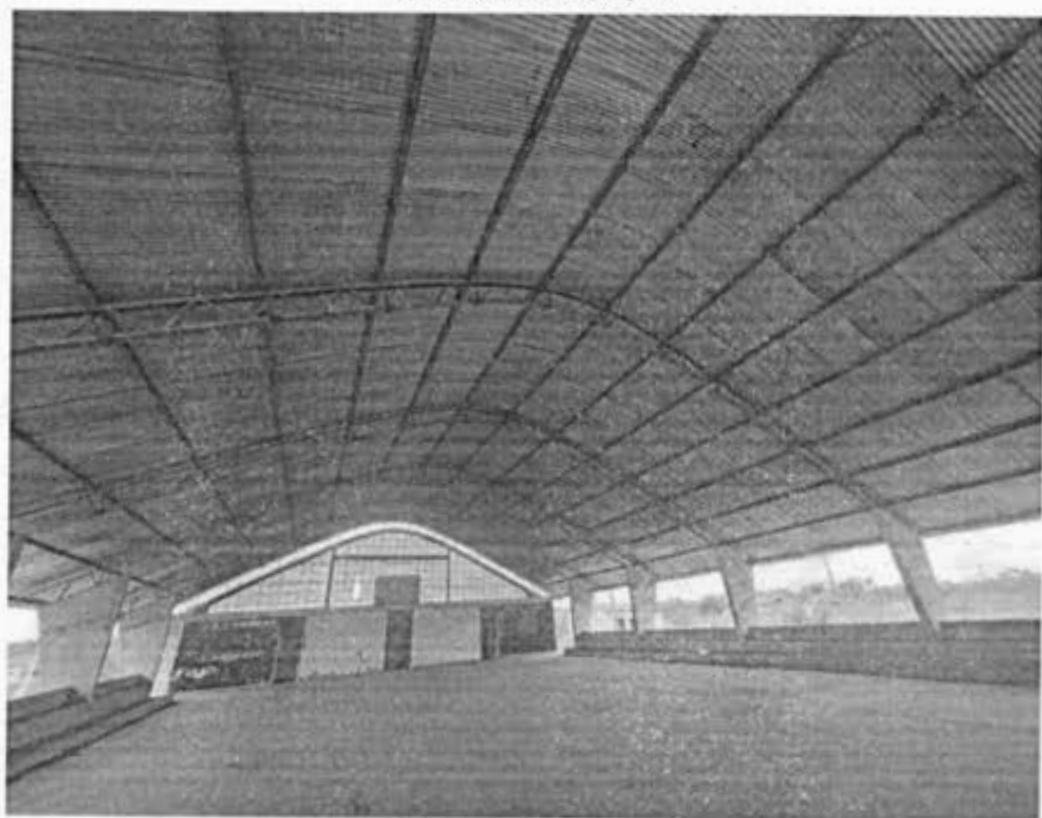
Quadra - Geometria divergente – arco executado com altura inferior a prevista
